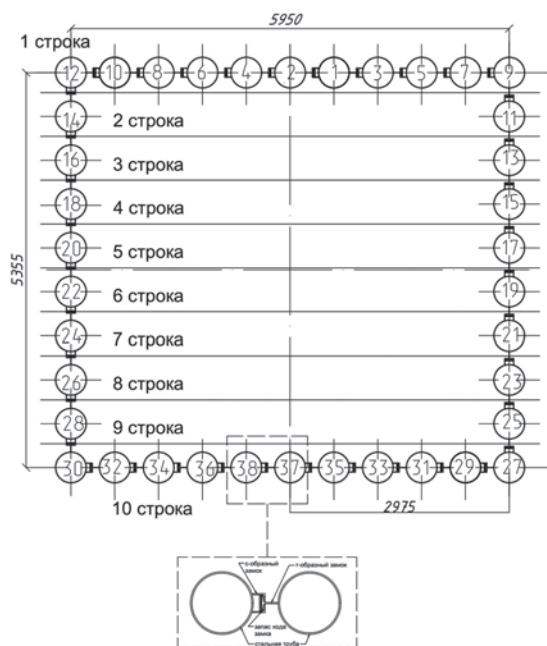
Поперечный разрез защитного экрана / Fig. 3. Cross-section of the pipe-roof structure
